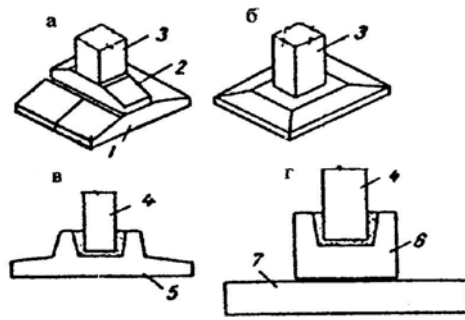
Збірні стовпчасті фундаменти:
